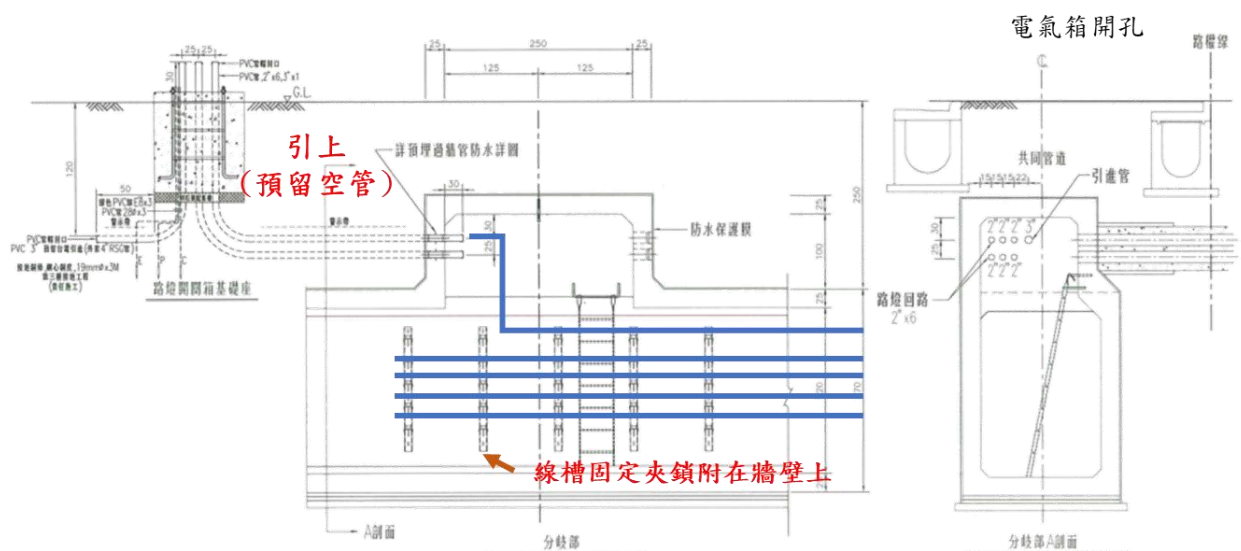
共同管道及分歧部實際施工圖範例
